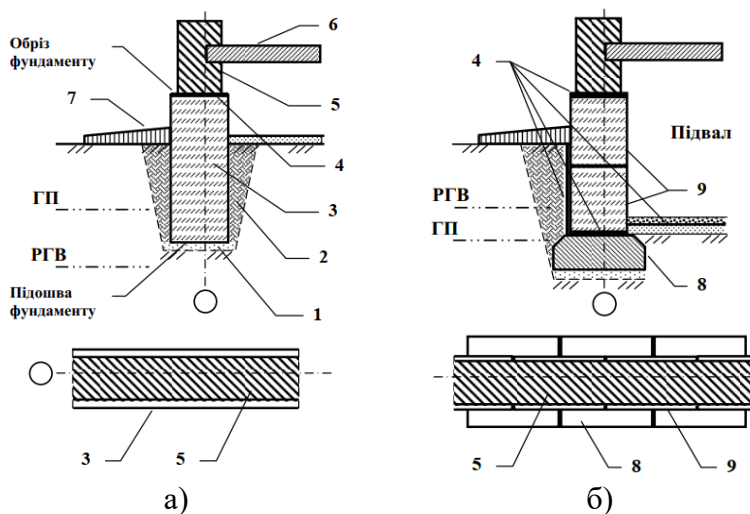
Розрізи стрічкових фундаментів: а) монолітний фундамент; б) збірний фундамент; ГП – глибина промерзання ґрунту; РГВ – рівень ґрунтових вод; 1 – основа; 2 – пазуха; 3 – фундаментна стіна; 4 – гідроізоляція; 5 – стіна; 6 – перекриття; 7 – вимощення; 8 – фундаментна плита; 9 – фундаментний блок
